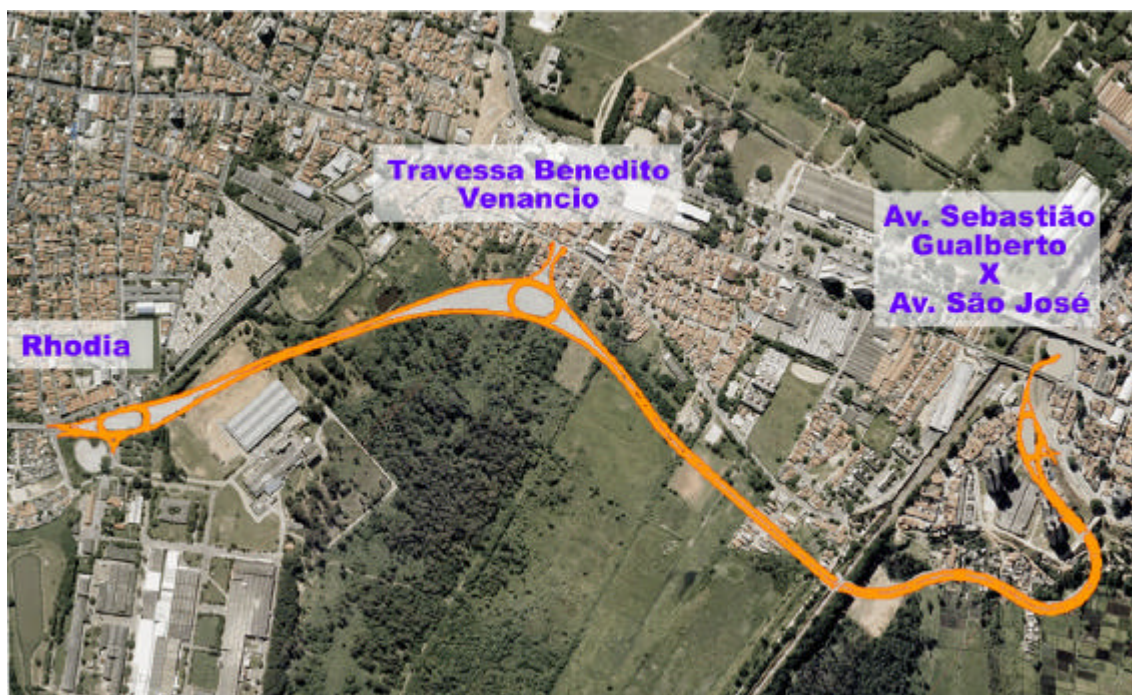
Traçado oficial da Via Norte em 2007. Fonte: PMSJC
